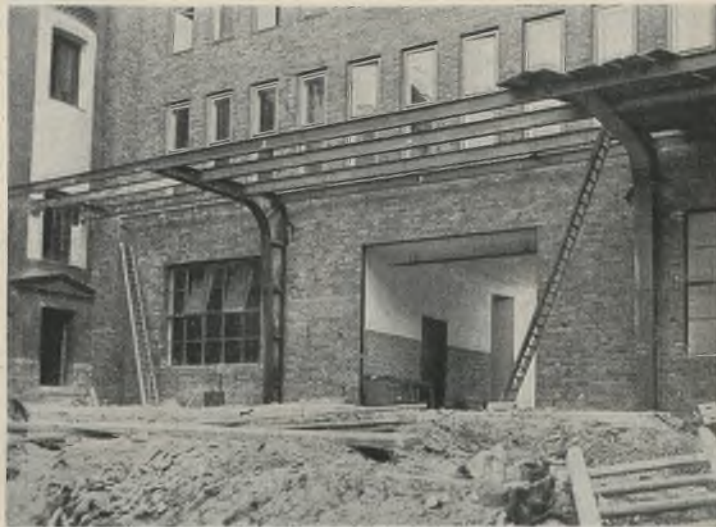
Geschweißte Stahlkonstruktion des Vordaches.
